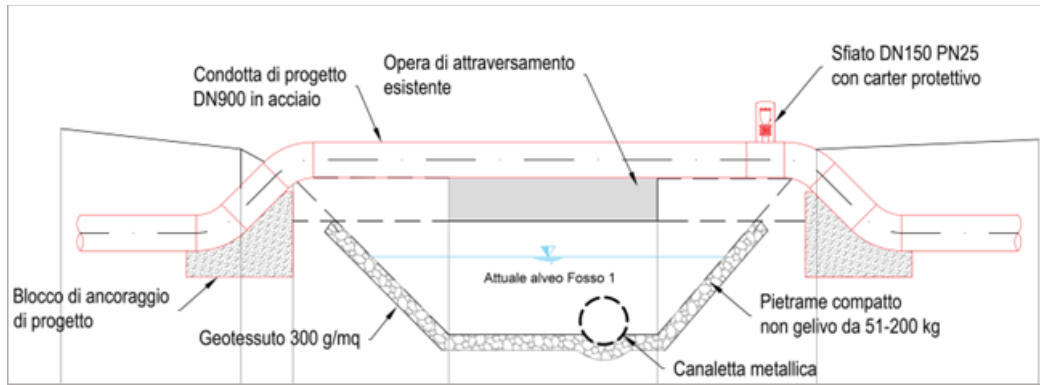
Sezione longitudinale attraversamento aereo autoportante di progetto sul Fosso Verde.
